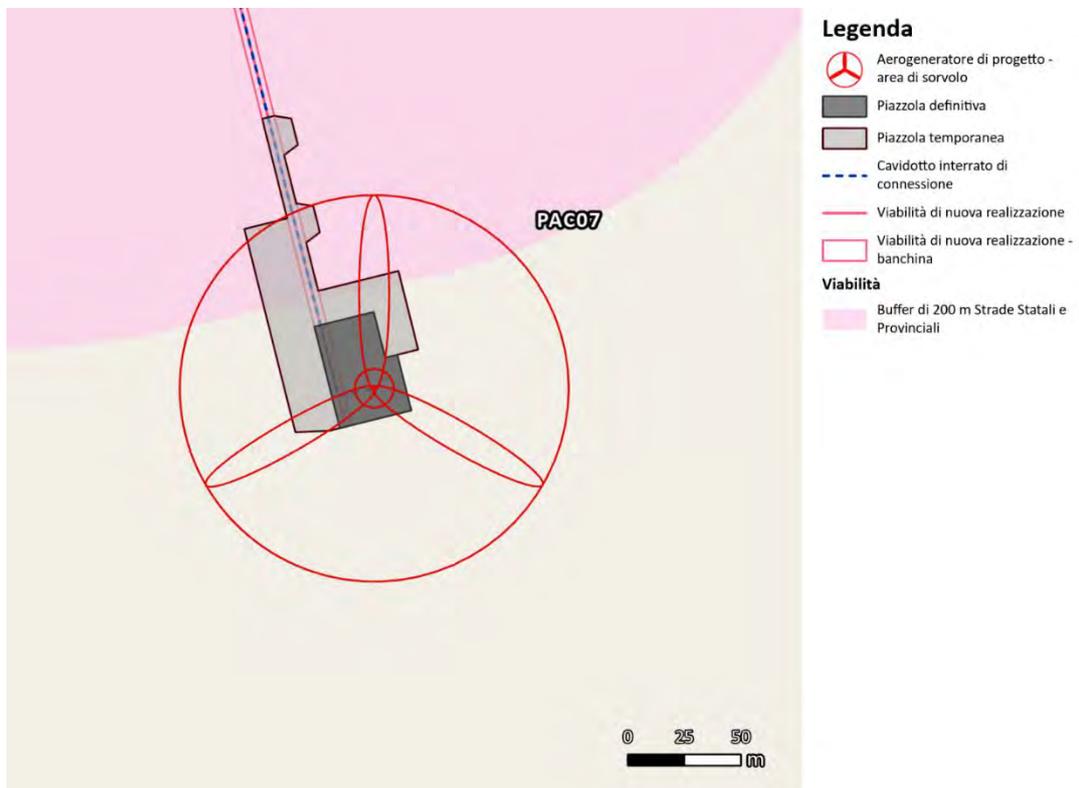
Distanze di rispetto dalle strade statali/provinciali. Zoom sulla WTG PAC07 in progetto
